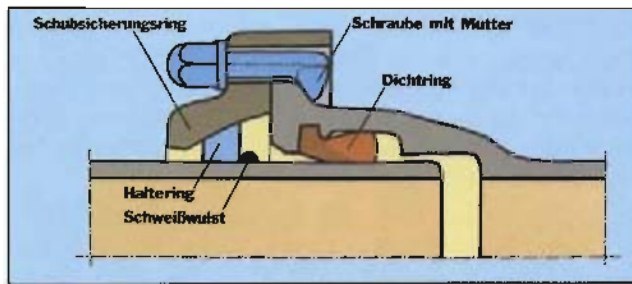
TYTON-Verbindung mit Schubsicherung TYS
